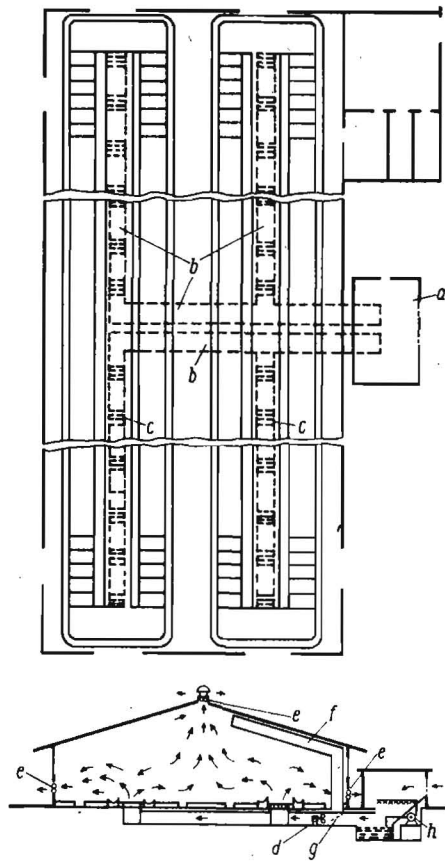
Grundriß und Querschnitt des Kuhstalles vom Typ K 250 DK
